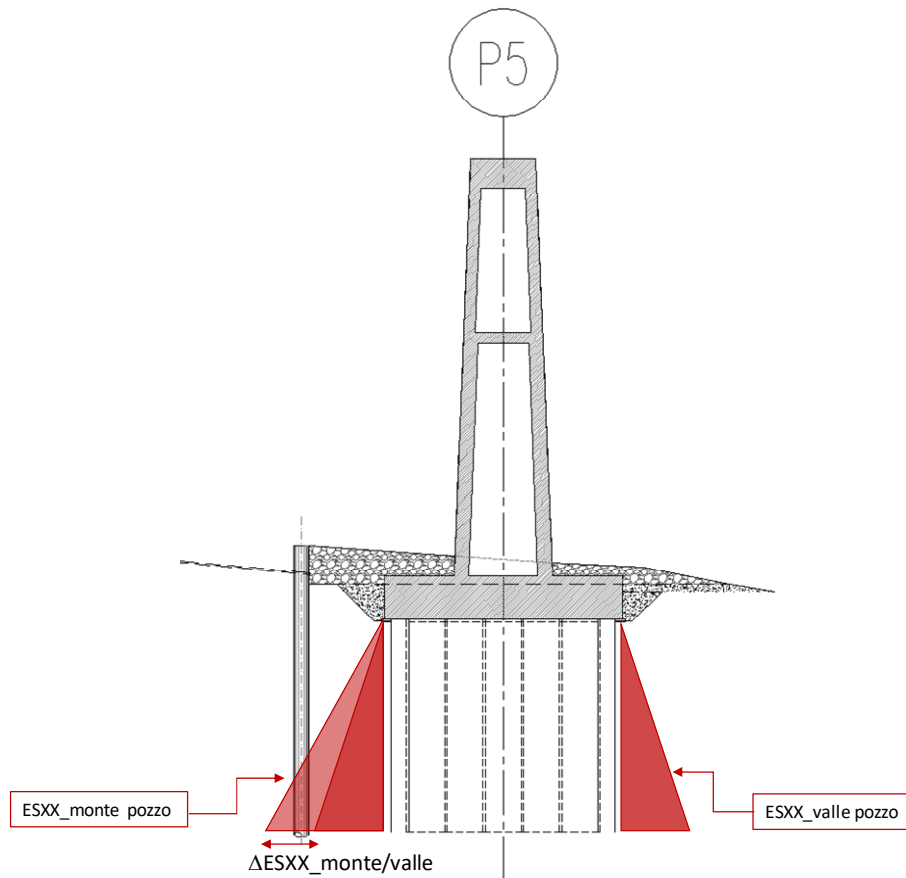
Viadotto VI03. Pila 5: tensioni a monte e valle del pozzo di fondazione
